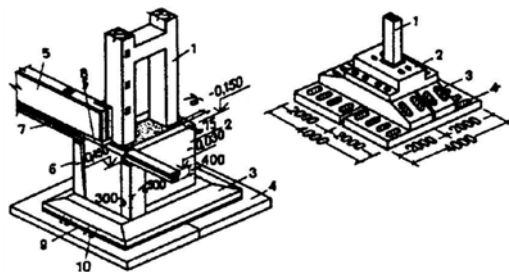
Фундаменти і опертя на них колони, фундаментних балок і цокольної панелі:
